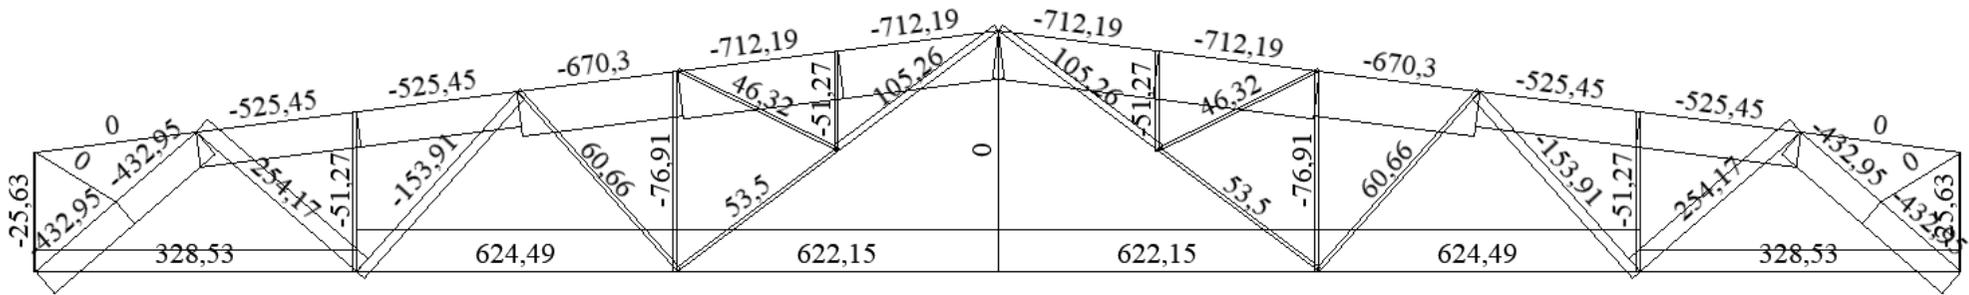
Эпюры внутренних усилий от основного сочетания нагрузок на стропильную ферму
